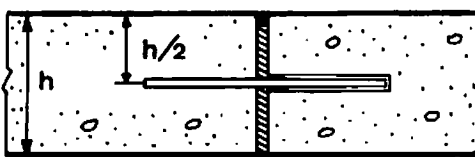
Position des joints longitudinaux de chaussée rigide.
